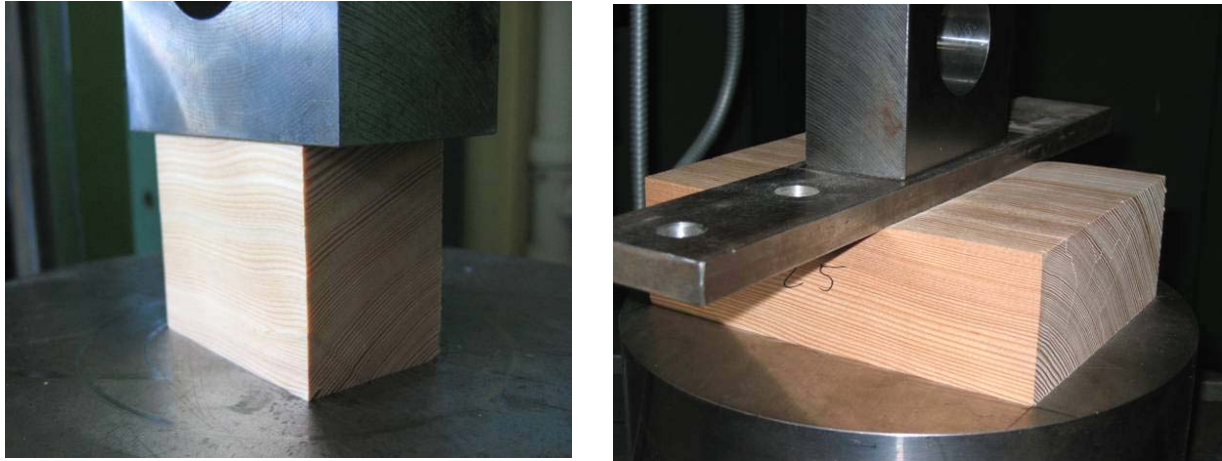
Versuchsaufbau Querdruckbeanspruchung: Fall 1 und Fall 2
